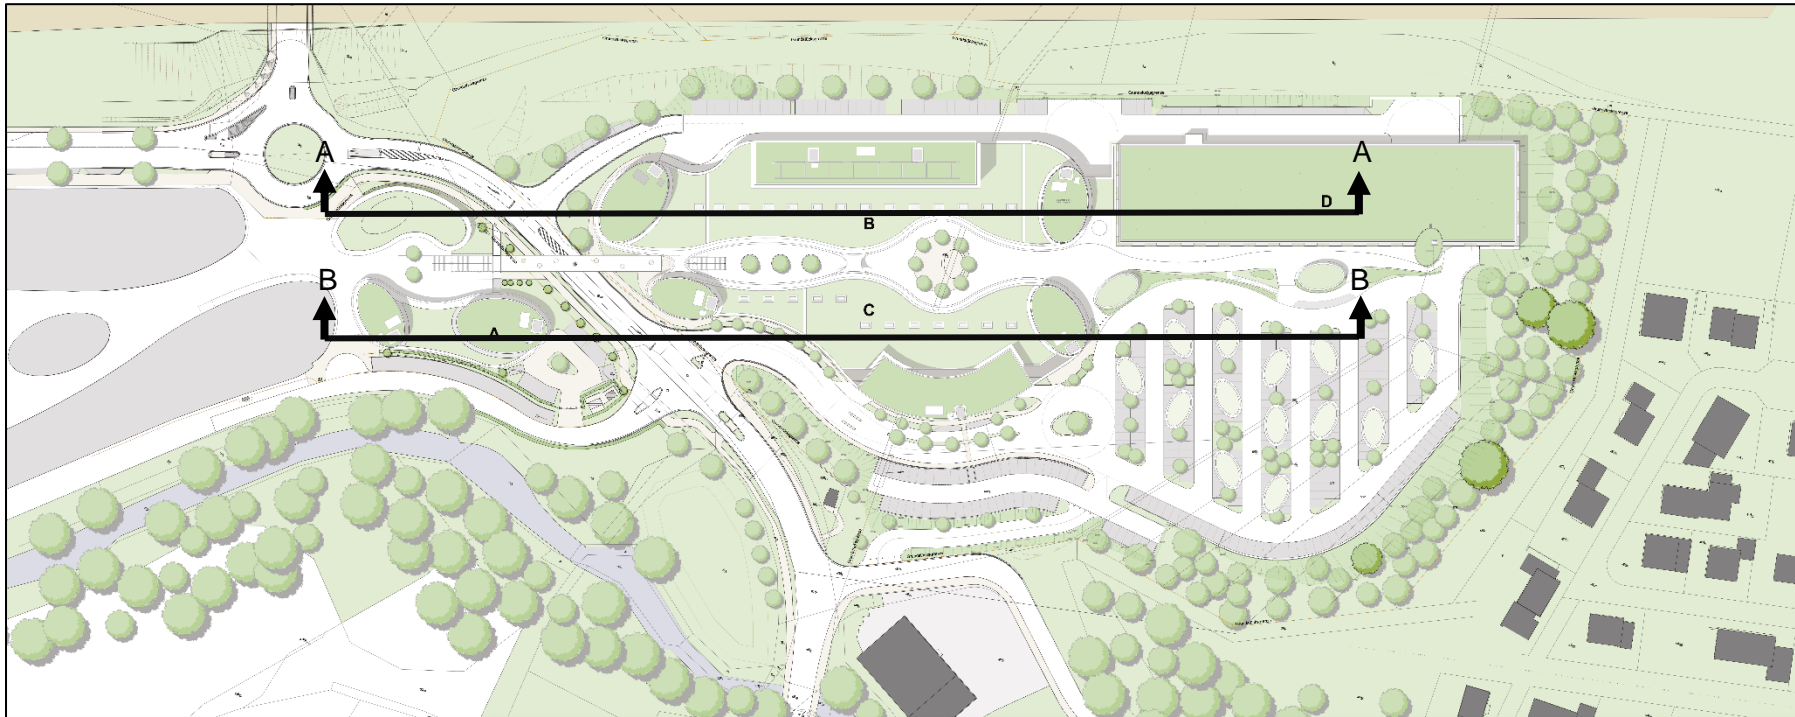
Baukonzept – Übersichtslageplan Erweiterung (ohne Maßstab)¹⁸
